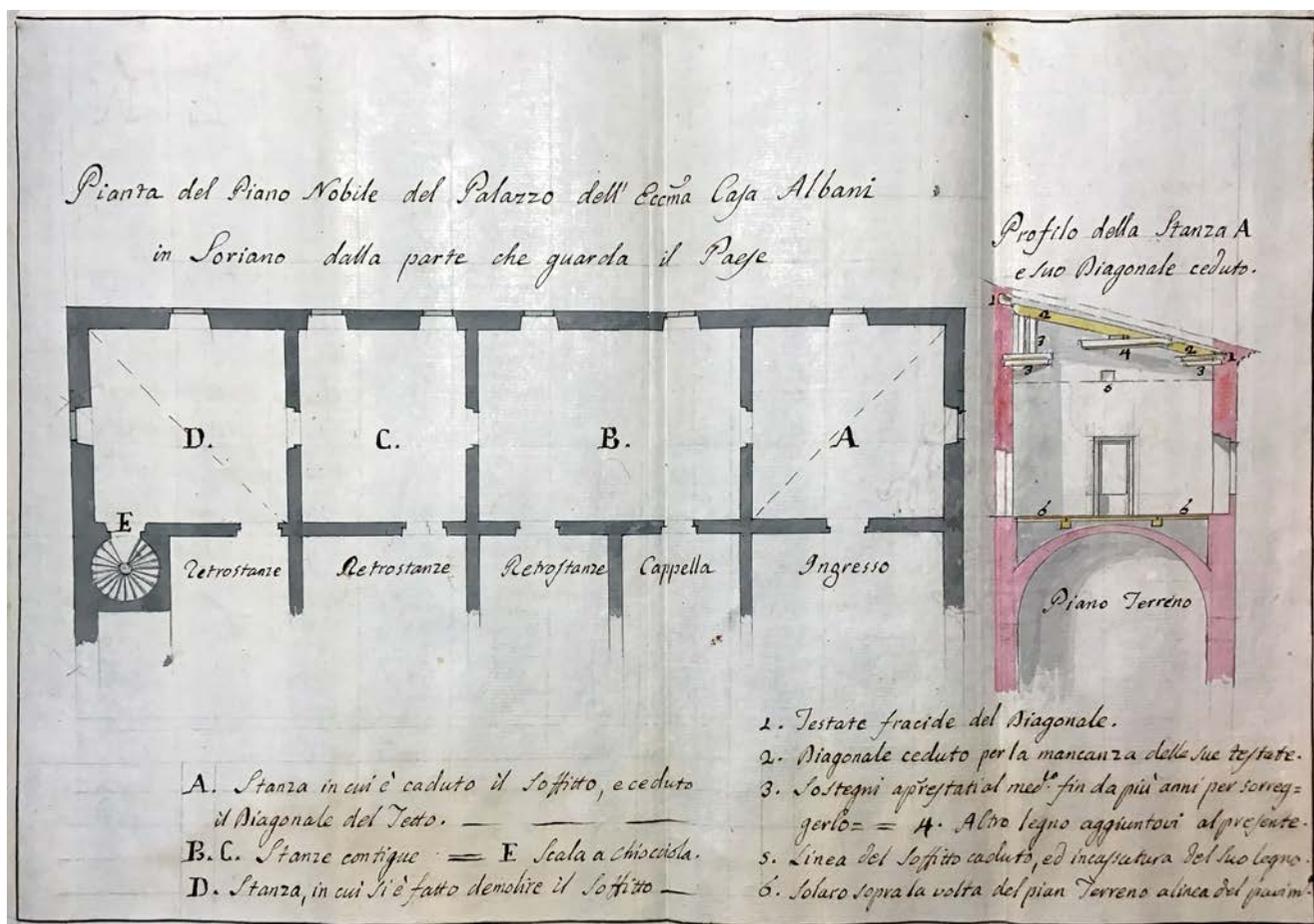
Benedetto Piernicoli, "Pianta del Piano Nobile del palazzo dell' Ecc^{ma} Casa Albani in Soriano dalla parte che guarda il paese", a lato: "Profilo della stanza A e suo diagonale ceduto", planimetria e sezione in china acquerellata (1807). ASR, fondo Albani, b. 60, fasc. Perizie, e Relazioni del Sig. r Piernicoli [...], cc. n. n., ad diem (su concessione del MiBACT, divieto di ulteriore riproduzione).
